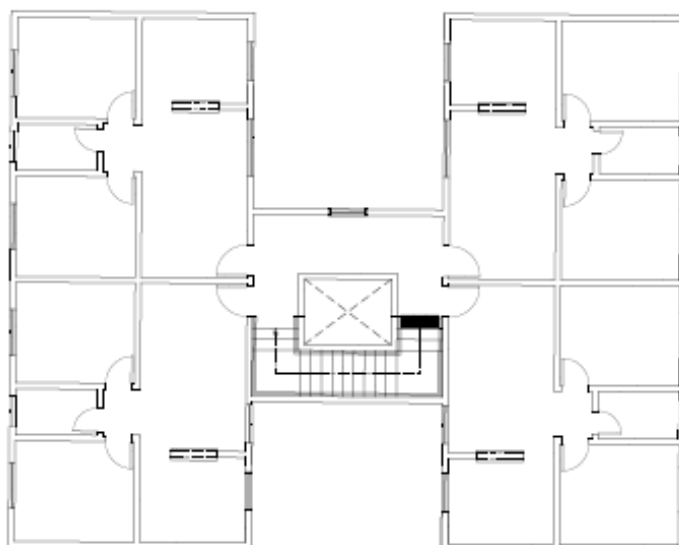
Planta do pavimento tipo em alvenaria estrutural sem escala.
